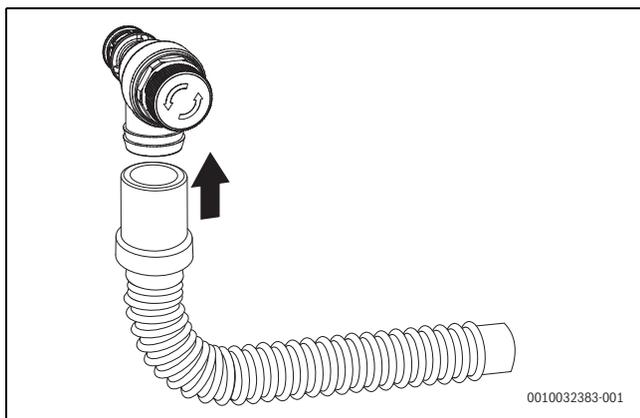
Montage du tube sur la soupape de sécurité (chauffage)
